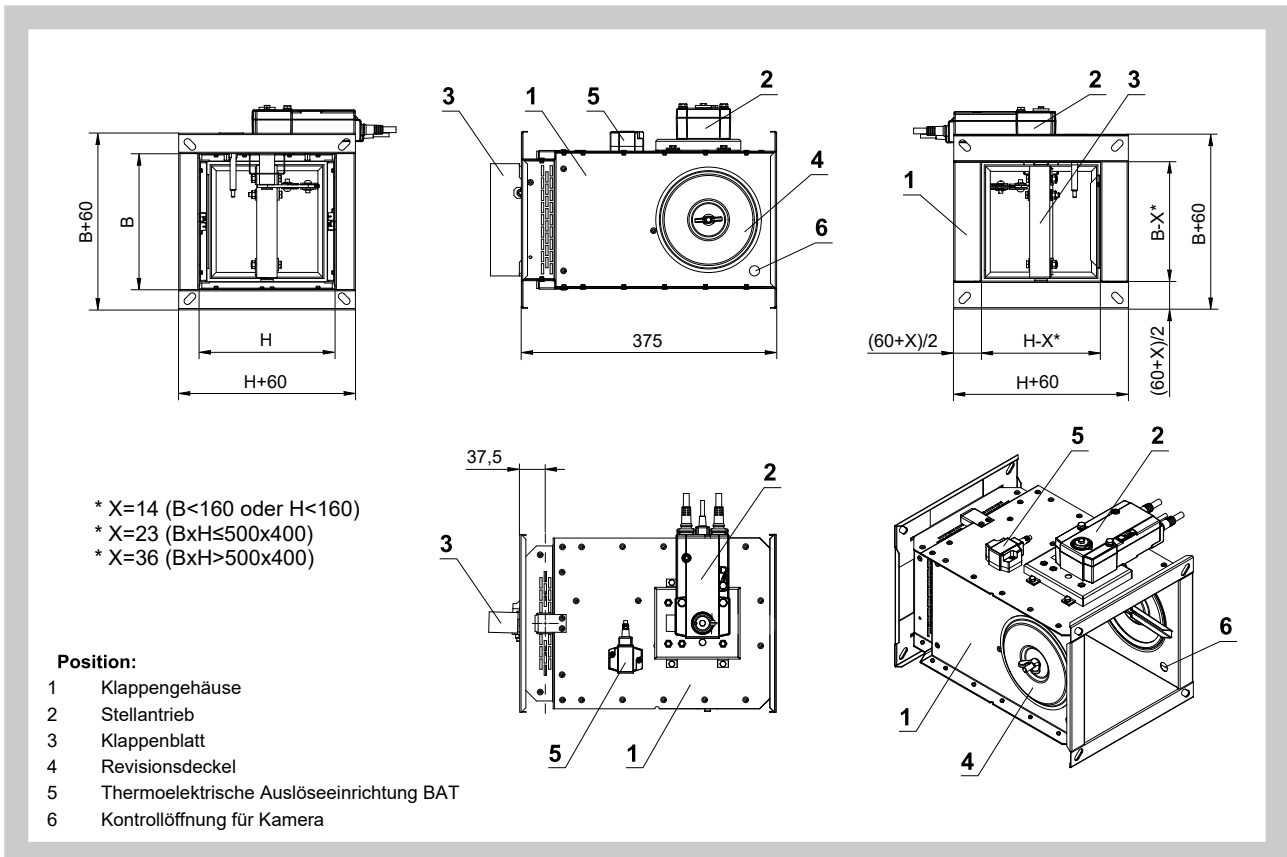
AUSFÜHRUNG MIT STELLANTRIEB
